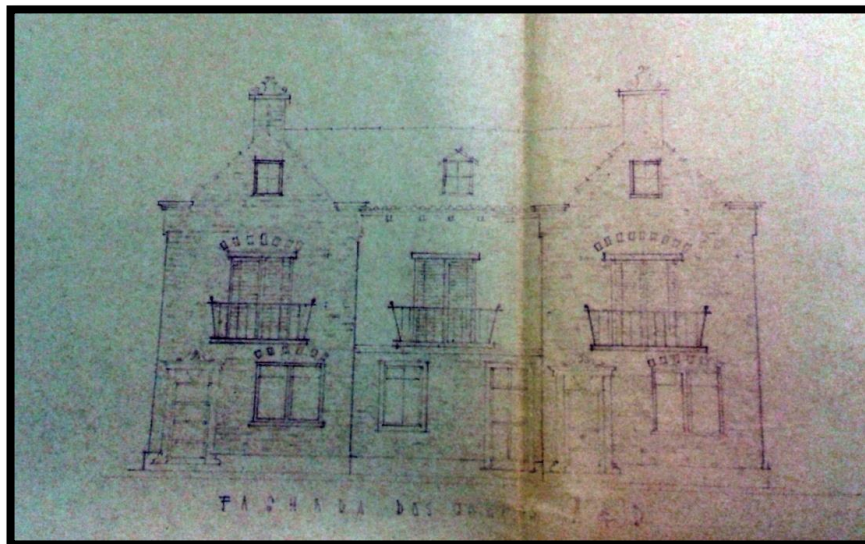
Projeto de fachada não construída. Fonte: 1982-0.022.567-4 – Planta 21.
